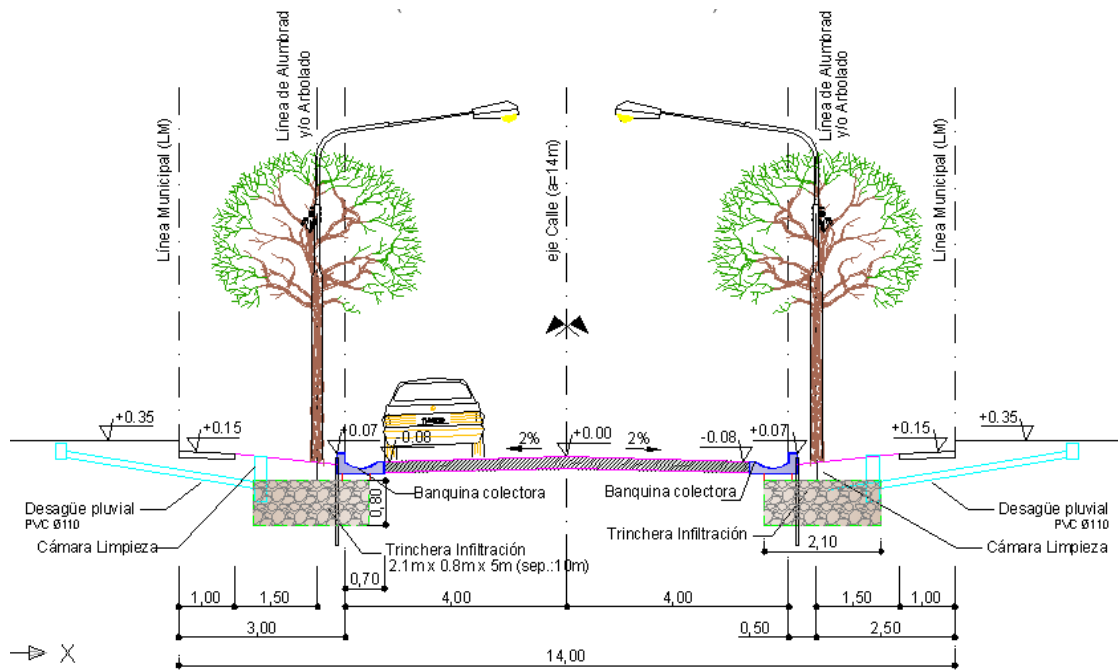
Perfil Tipo para calle de 14m (Trincheras de infiltración bajo banquina colectora)
